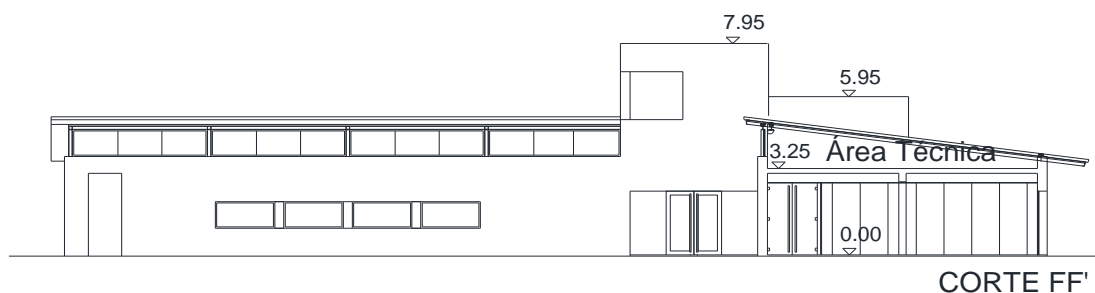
Corte FF' indicado na planta da fig. 36.
